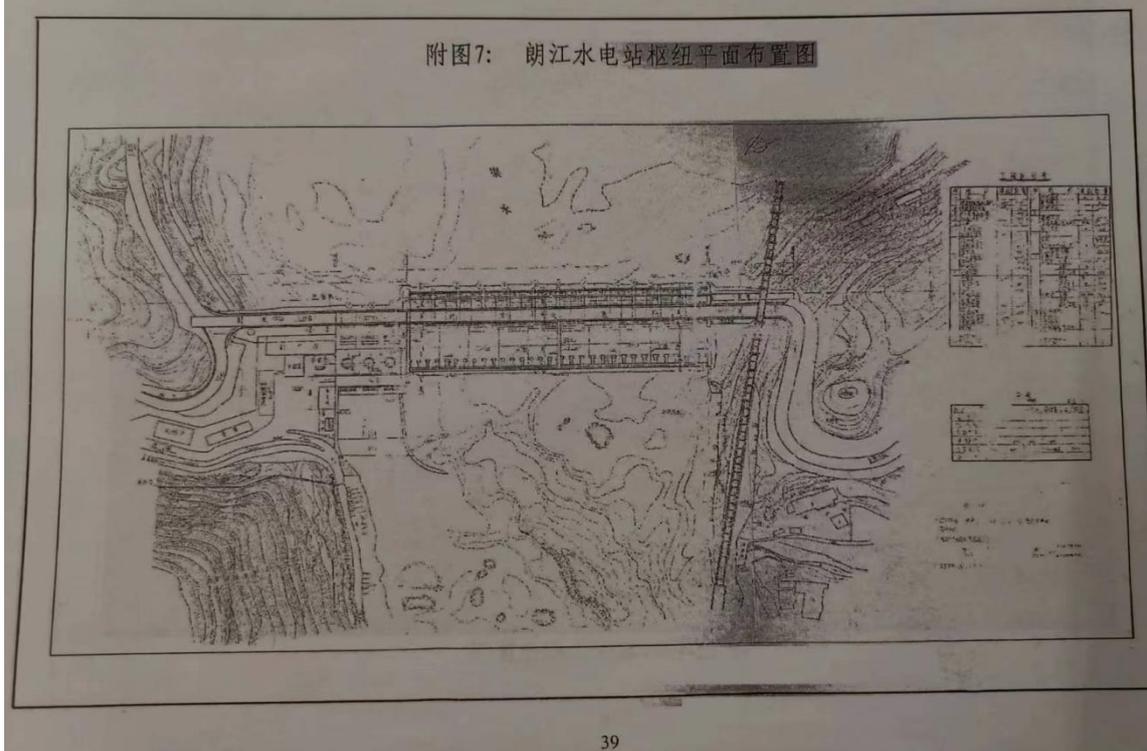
朗江电站水库工程位置图及枢纽平面布置图
